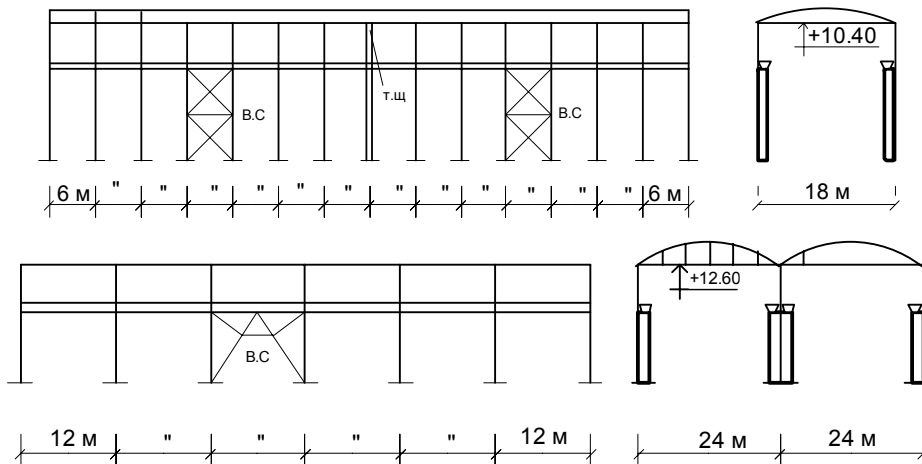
Влаштування вертикальних зв'язків по колонах в одноповислових промбудівлях:
